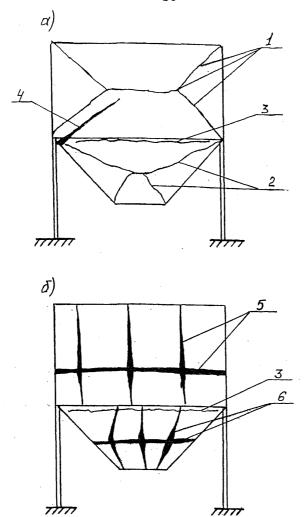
Трещины от нагрузки в железобетонных бункерах а - прямоугольный бункер; б - цилиндрический бункер (резервуар) с коническим днищем; 1 - трещины перегрузки в призматической части; 2 - тоже пирамидальной воронки; 3 - трещина от отрыва воронки; 4 - трещина от общего изгиба бункера; 5 - трещины от перегрузки при разрушении цилиндрической части; 6 - тоже конической части
